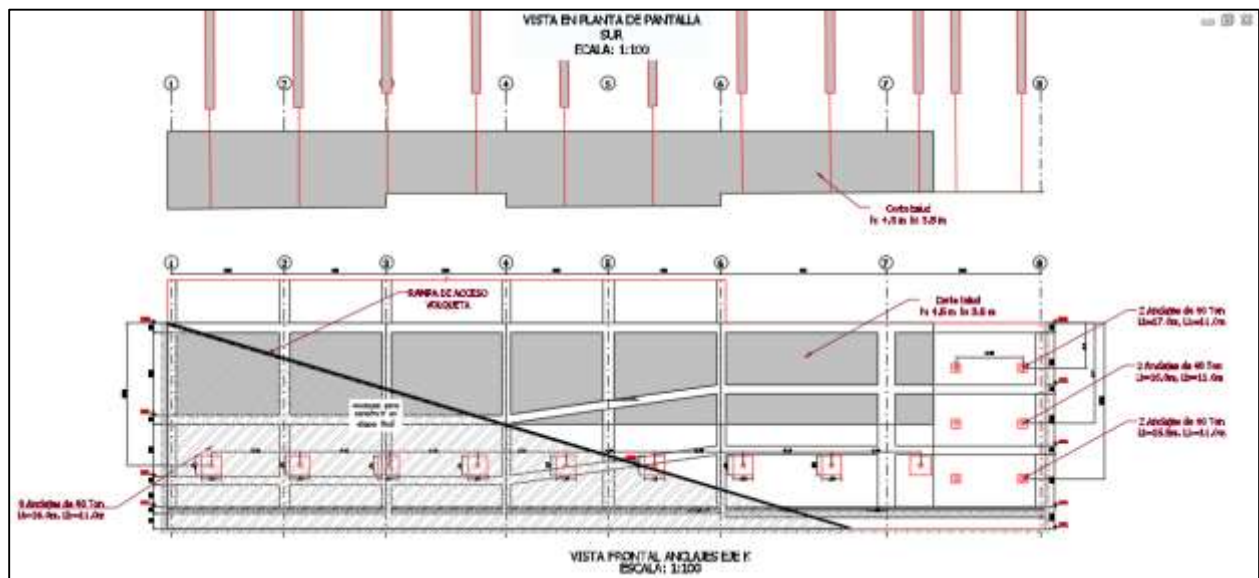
Vista en alzada y planta de Pantalla Sur - Proyecto San Agustín
